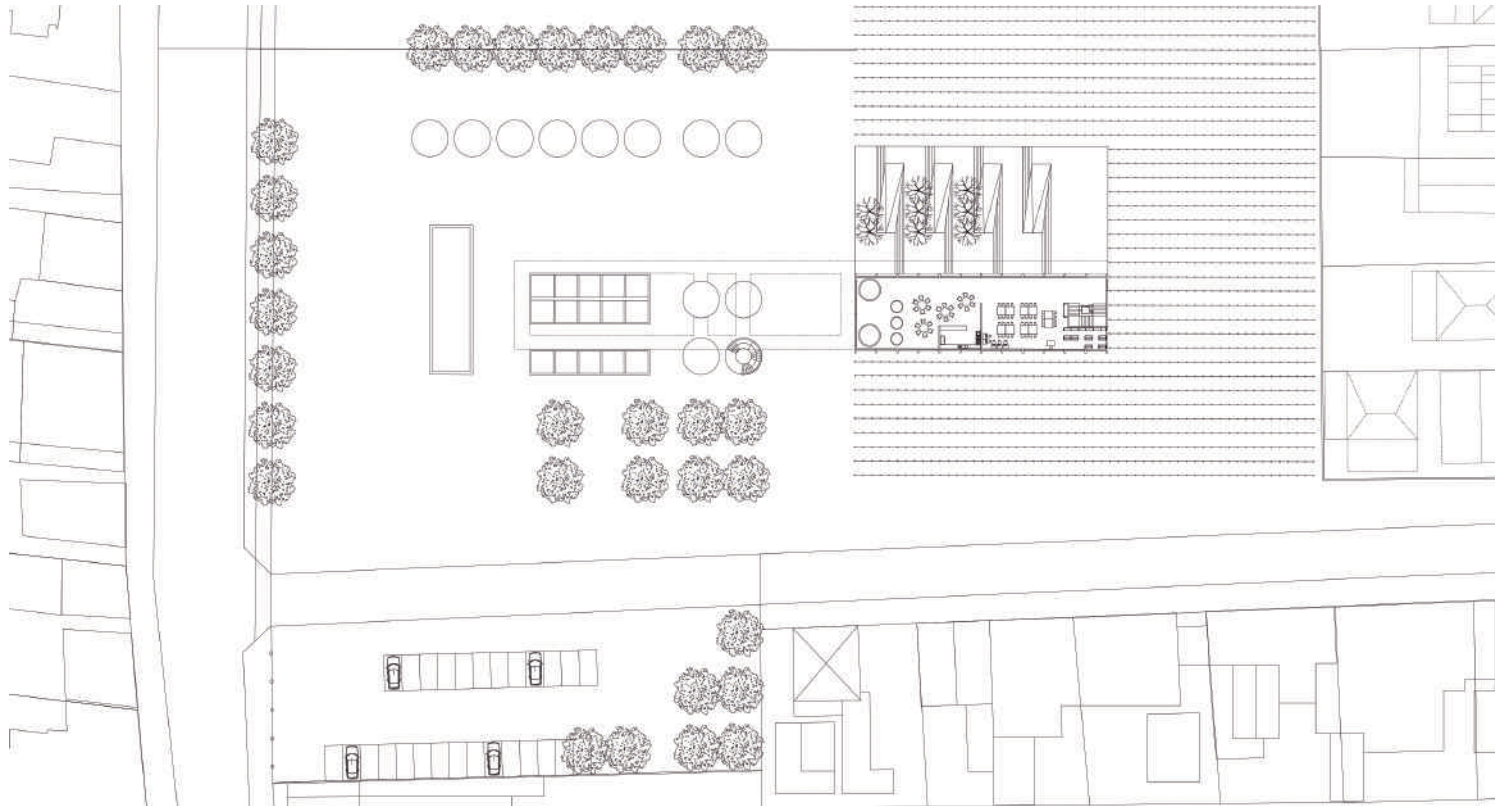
Planta CFT Nivel 1. Fuente: Elaboración propia.
